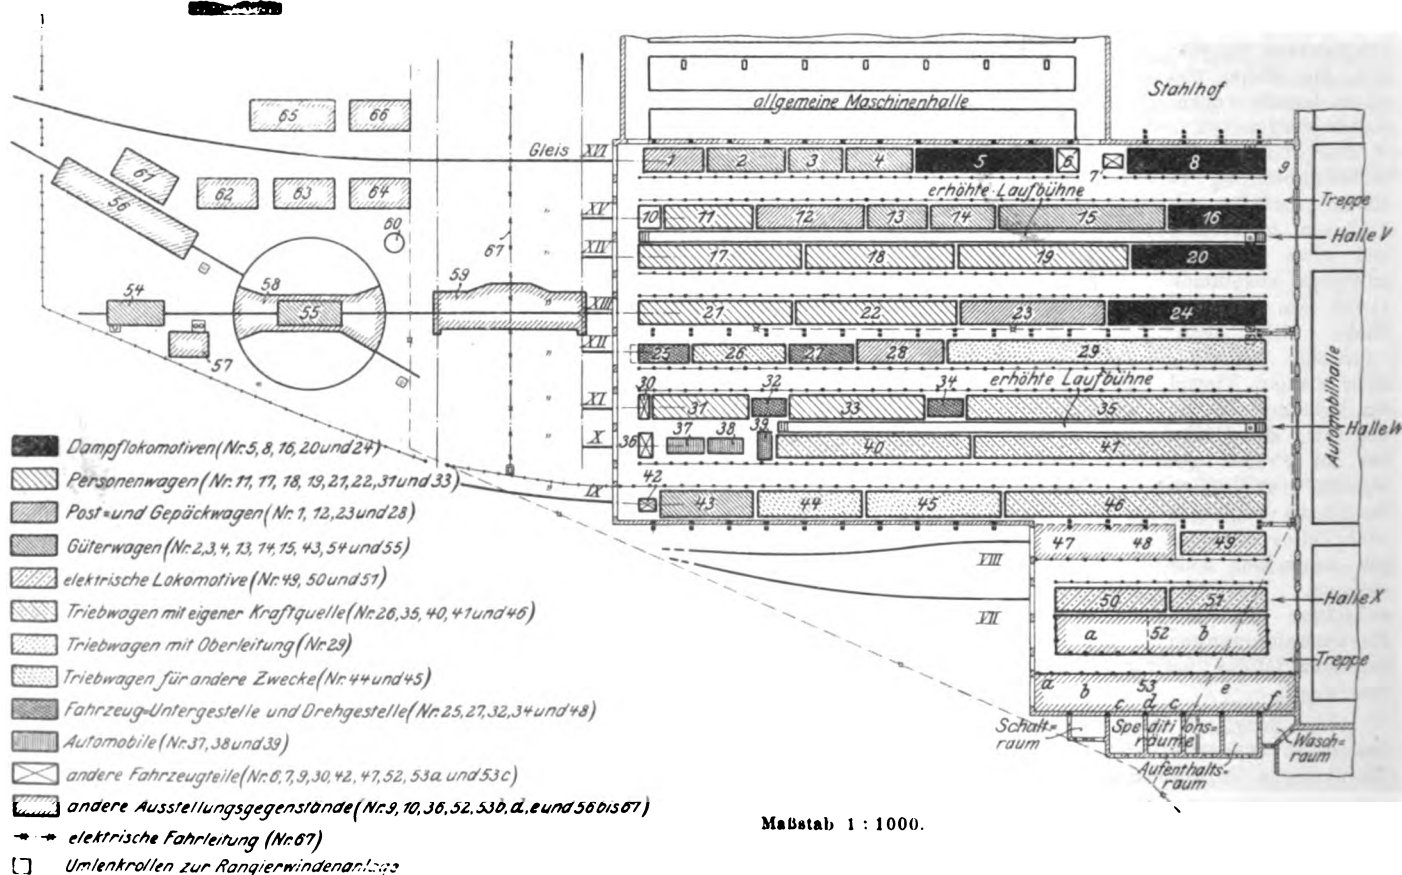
Lageplan der deutschen Eisenbahnausstellung (Hall V, W und X sowie Ausstellung im Freien).
